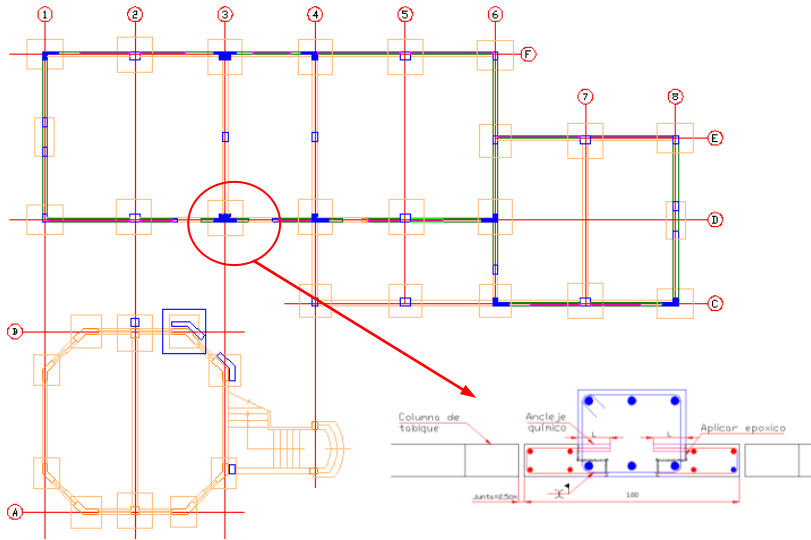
Muestra el planteamiento de reforzamiento en las columnas.
